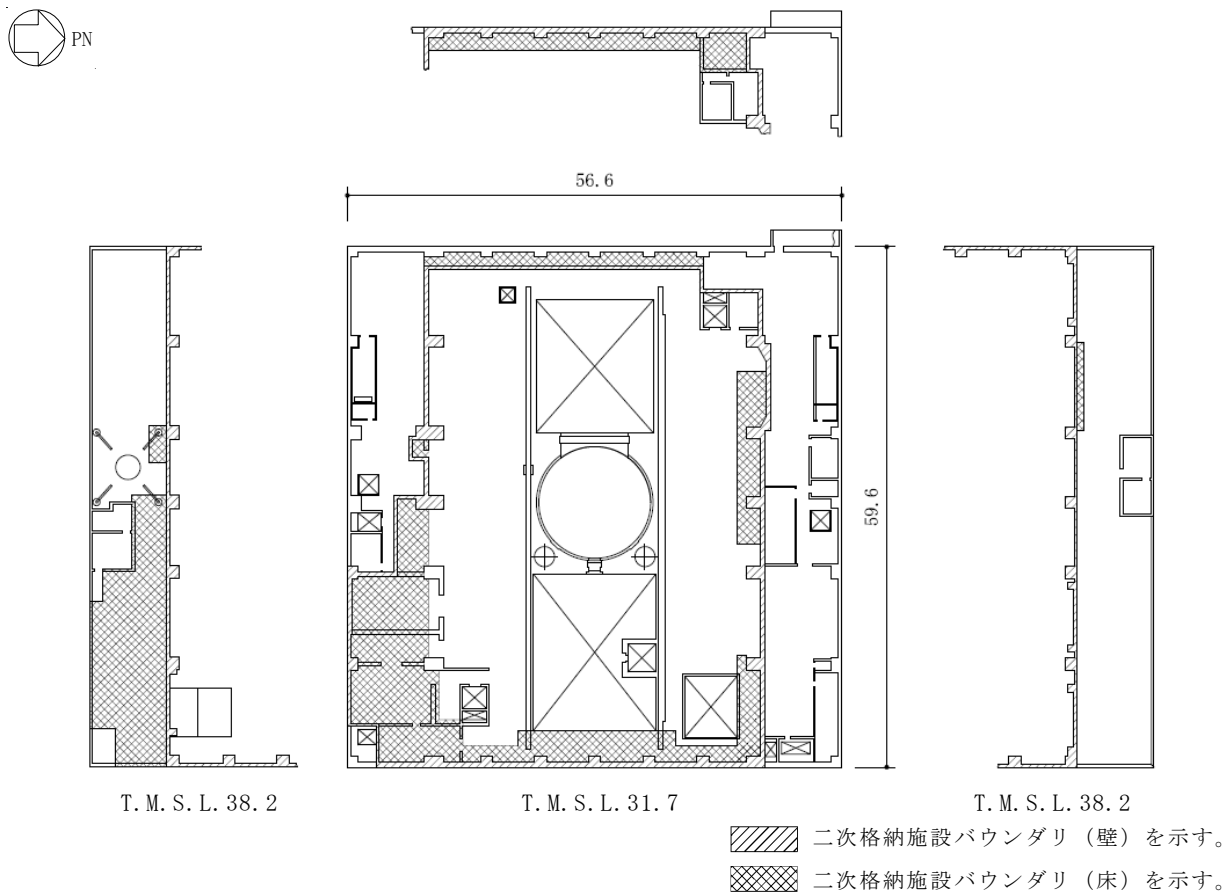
原子炉建屋原子炉区域（二次格納施設）の範囲の平面図
